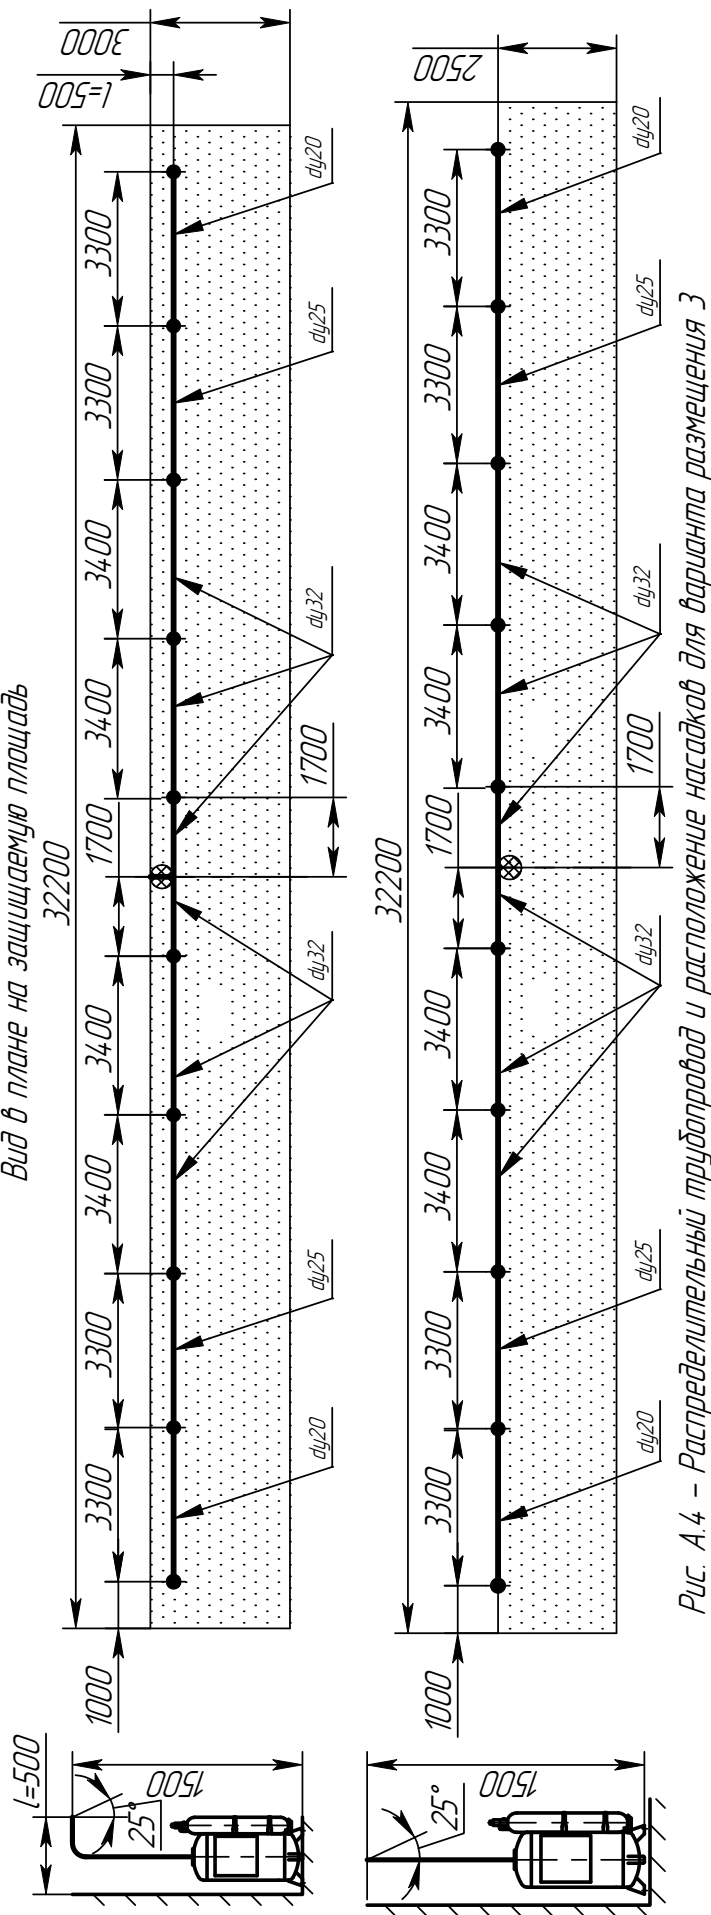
Распределительный трубопровод и расположение насадок для варианта размещения 3
